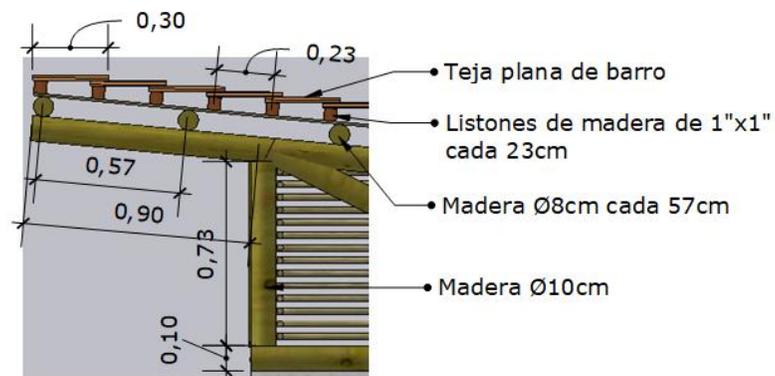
Vista isometrica*6.8.2 Detalles constructivosFigura 92*Persiana en madera
